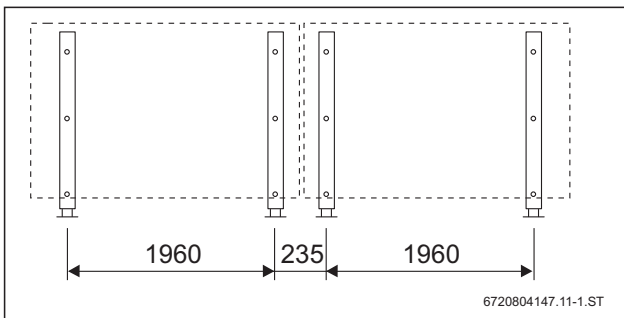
Abstände der Kollektorstützen bei Grundausführung für 2 waagerechte SKT1.0-w oder SKS5.0-w (Maße in mm)
